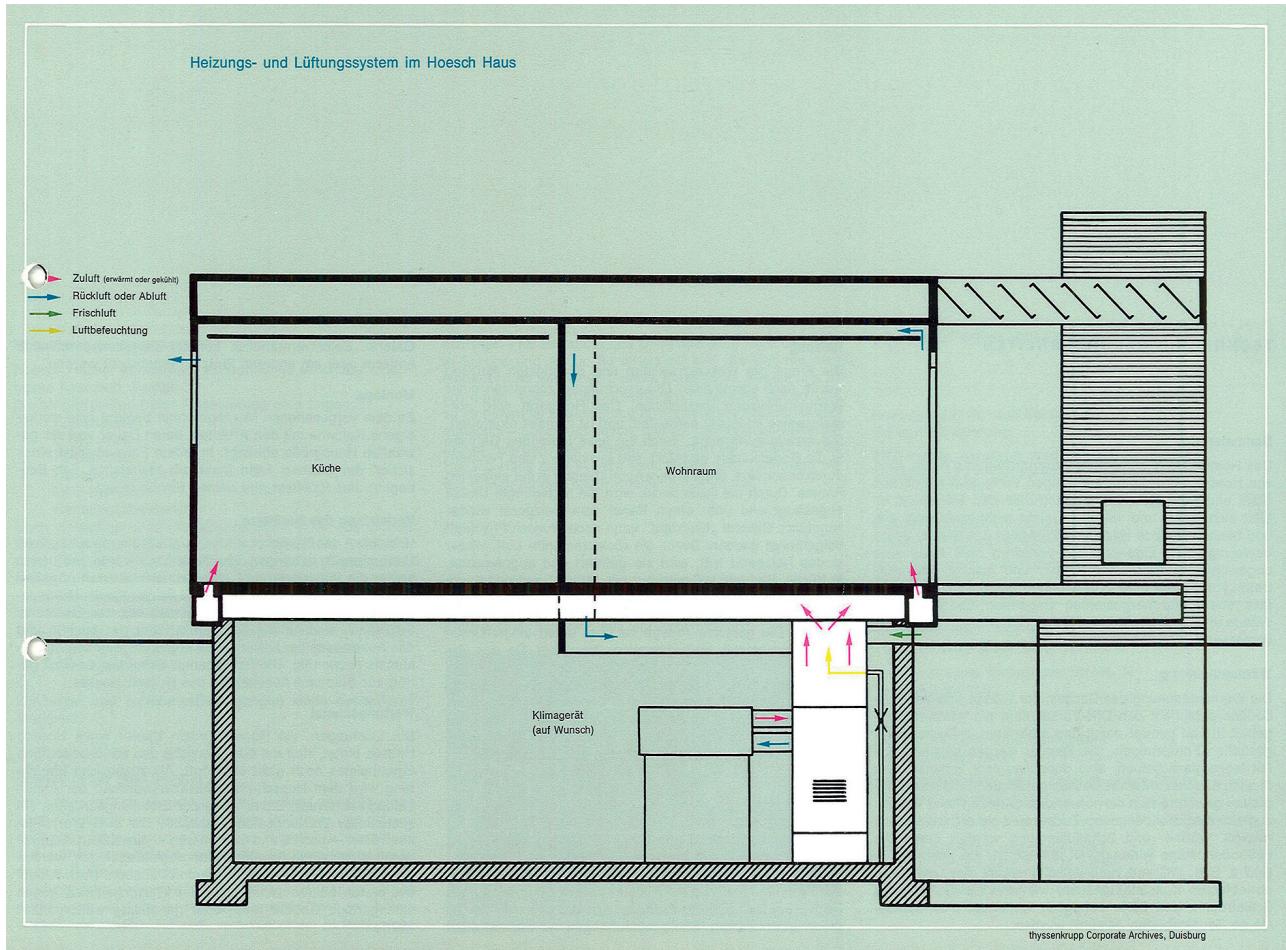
Heizungs- und Lüftungssystem im Hoesch Haus, Zeichnung undatiert, publiziert 1966.
